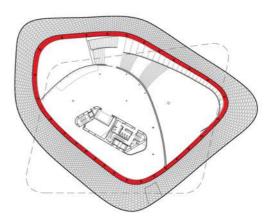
Planta baja museo Soumaya retomada de Archdaily.
